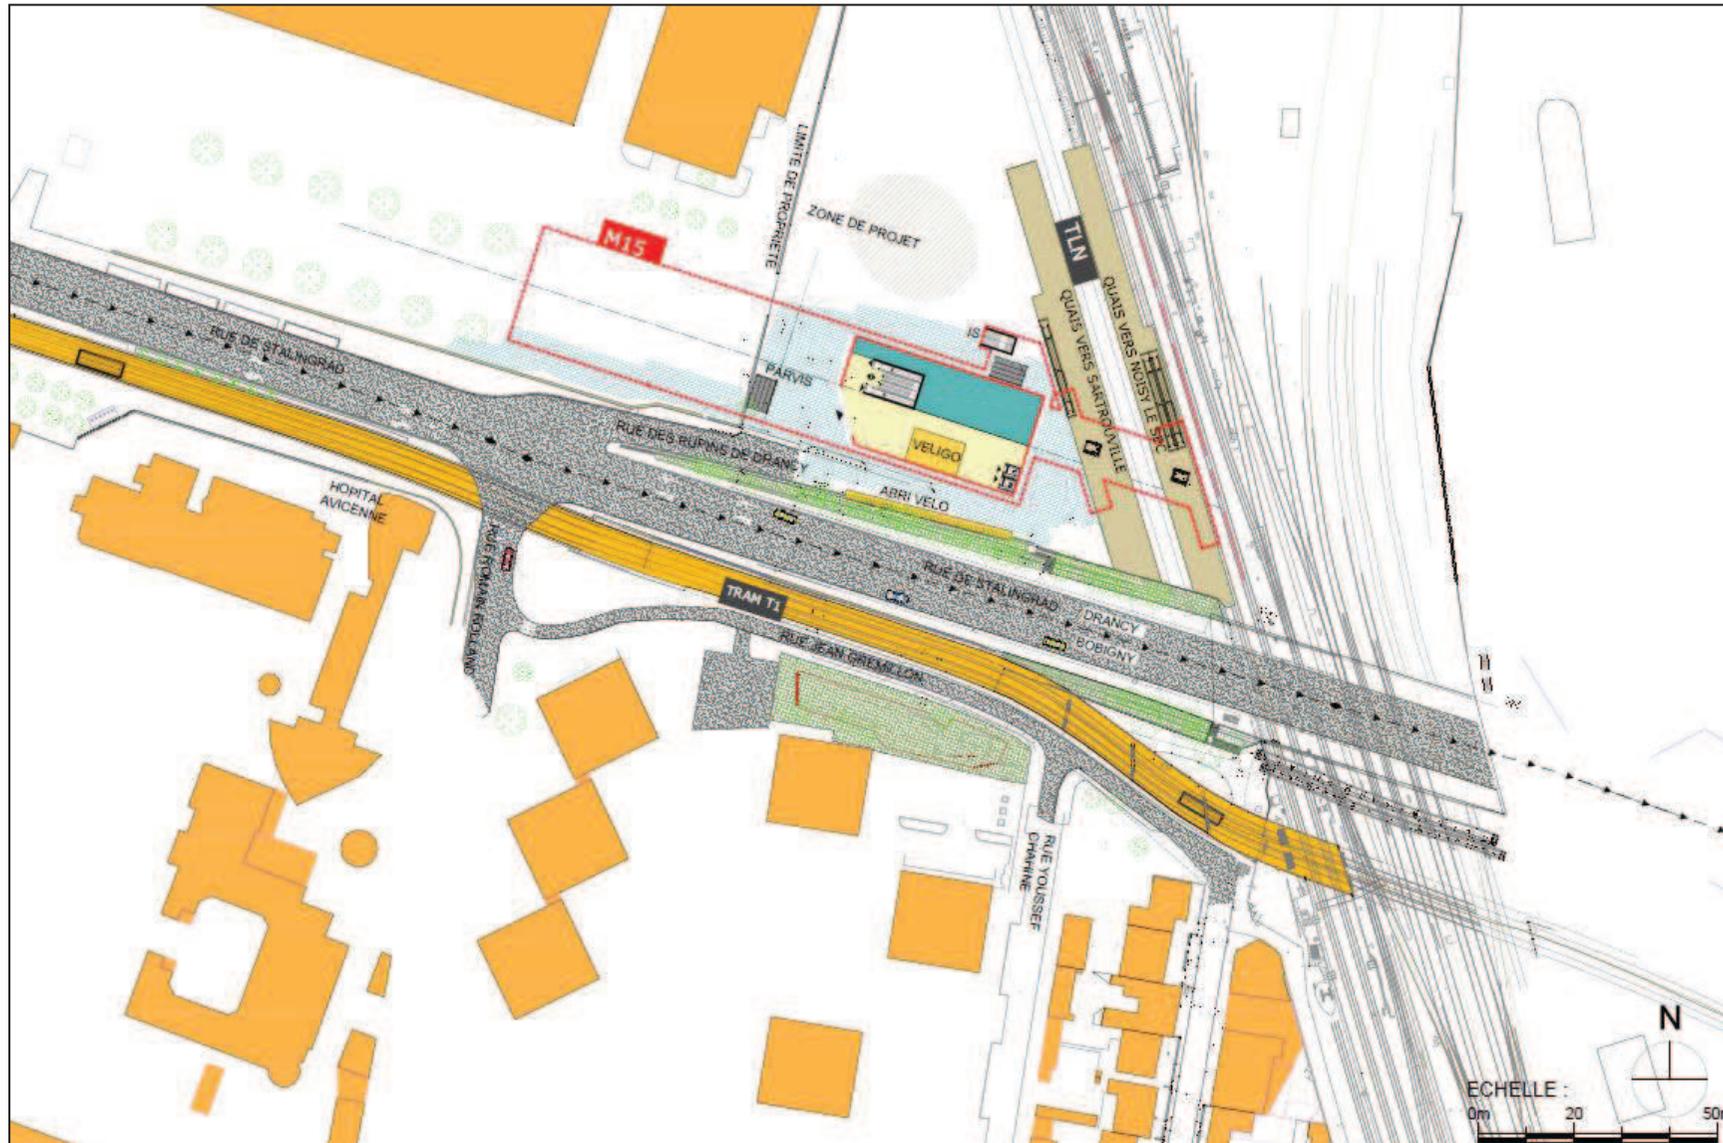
Vue en plan générale de la station Drancy-Bobigny
